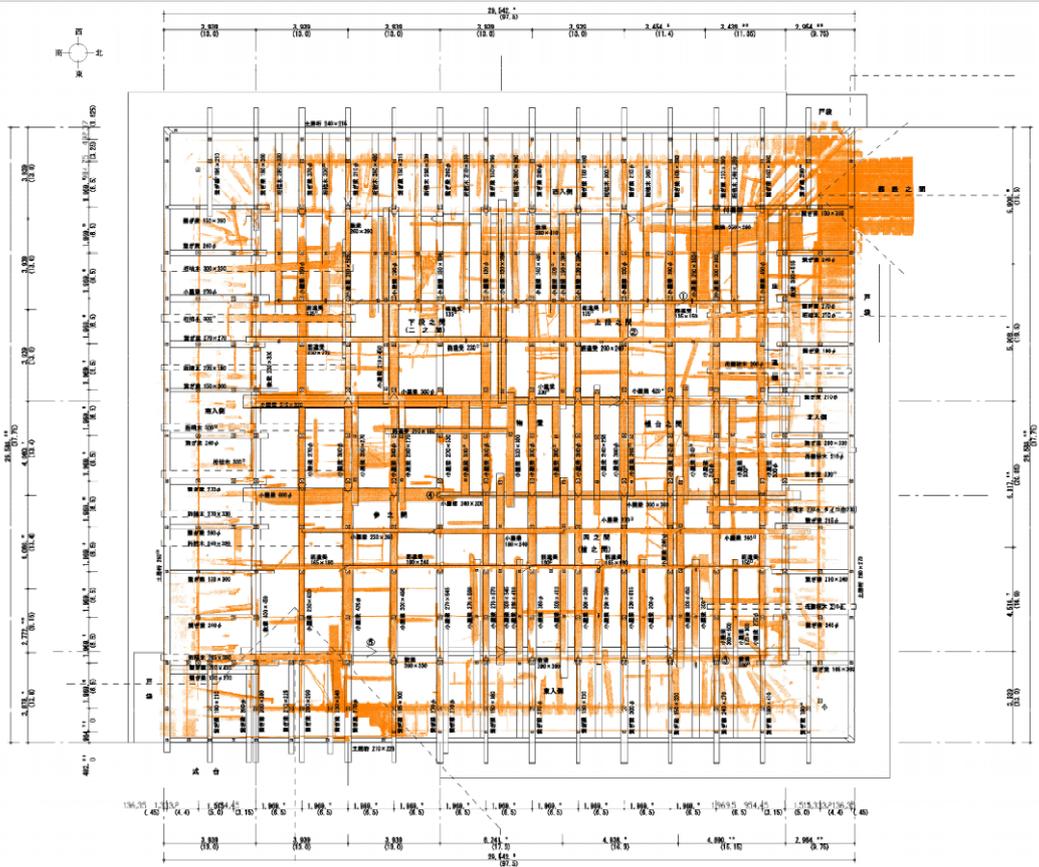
3次元計測結果と平面図の比較 大広間 平面
